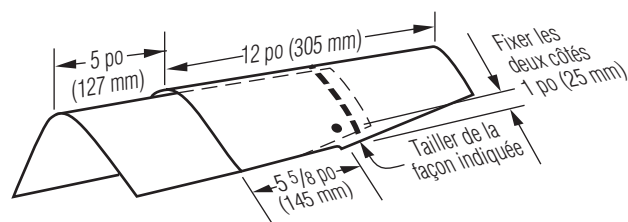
Installation des bardeaux de faîtage sur les arêtes et les faîtes.
